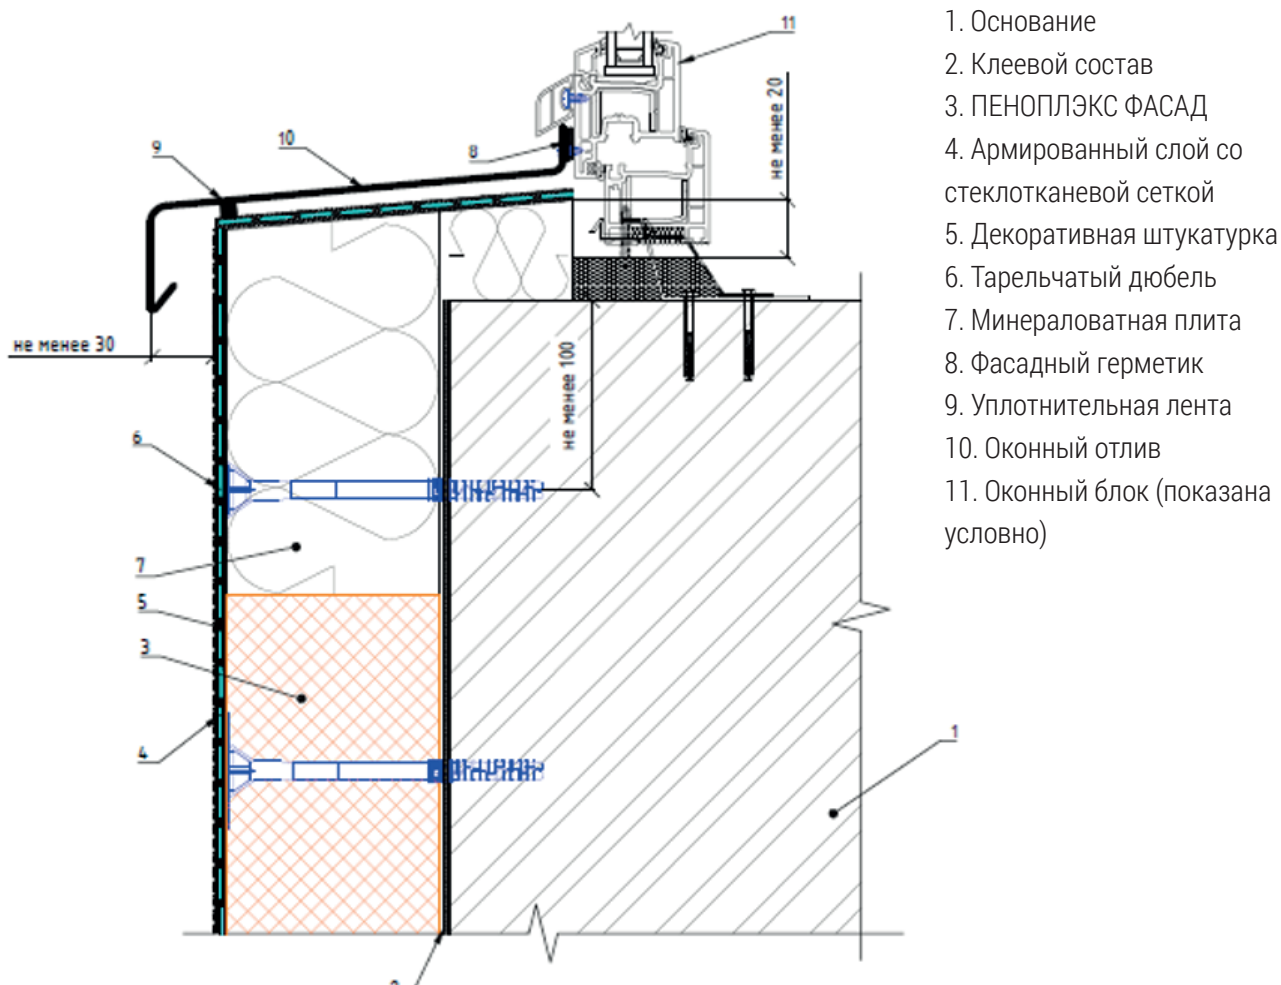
Вариант нижнего узла примыкания к оконному проему с теплоизоляцией
